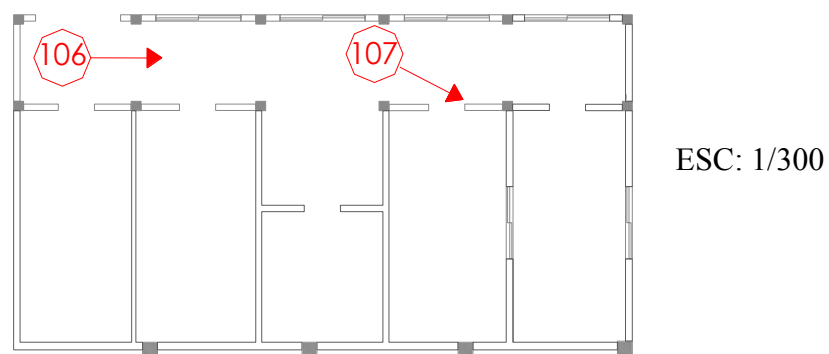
Planta Subterránea 3: Ubicación vista de fotografía
